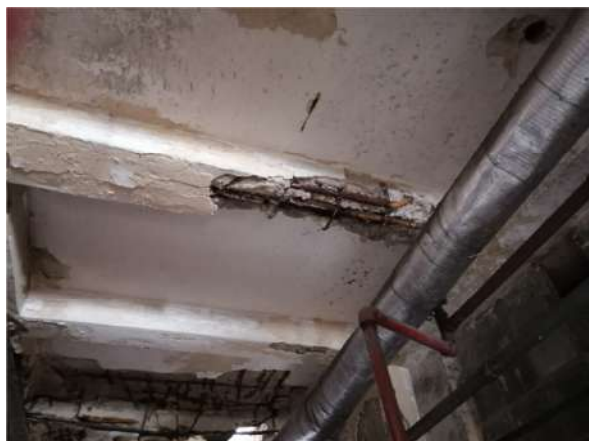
Chybějící krycí vrstva betonu a korodující výztuž
